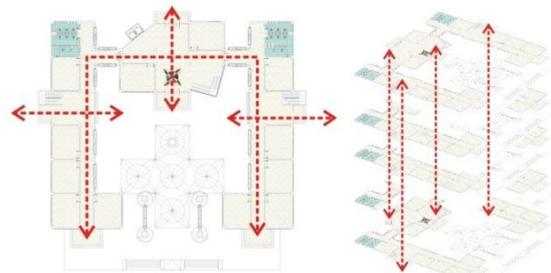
Zonning Horizontal Bangunan Pengajaran
